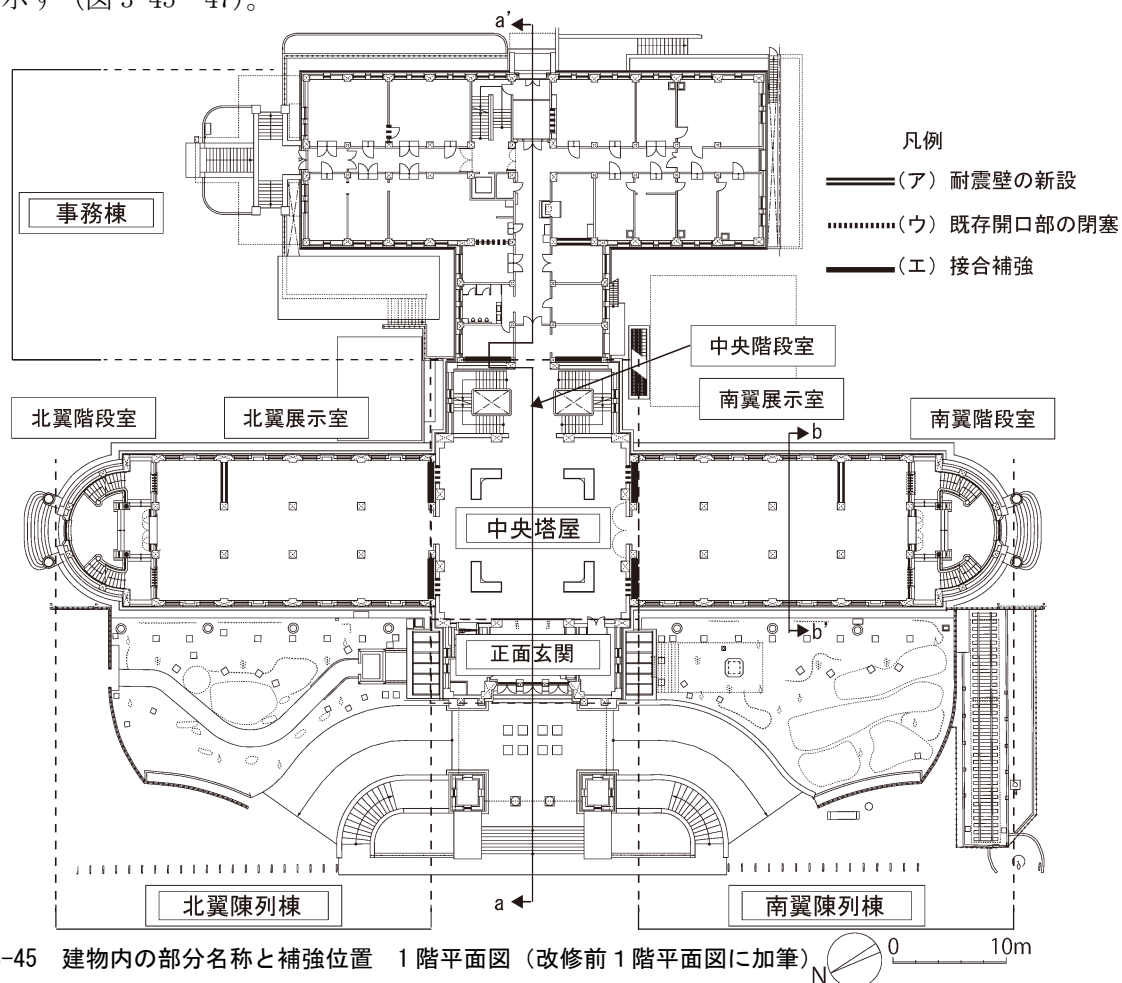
建物内の部分名称と補強位置 1 階平面図（改修前 1 階平面図に加筆）
